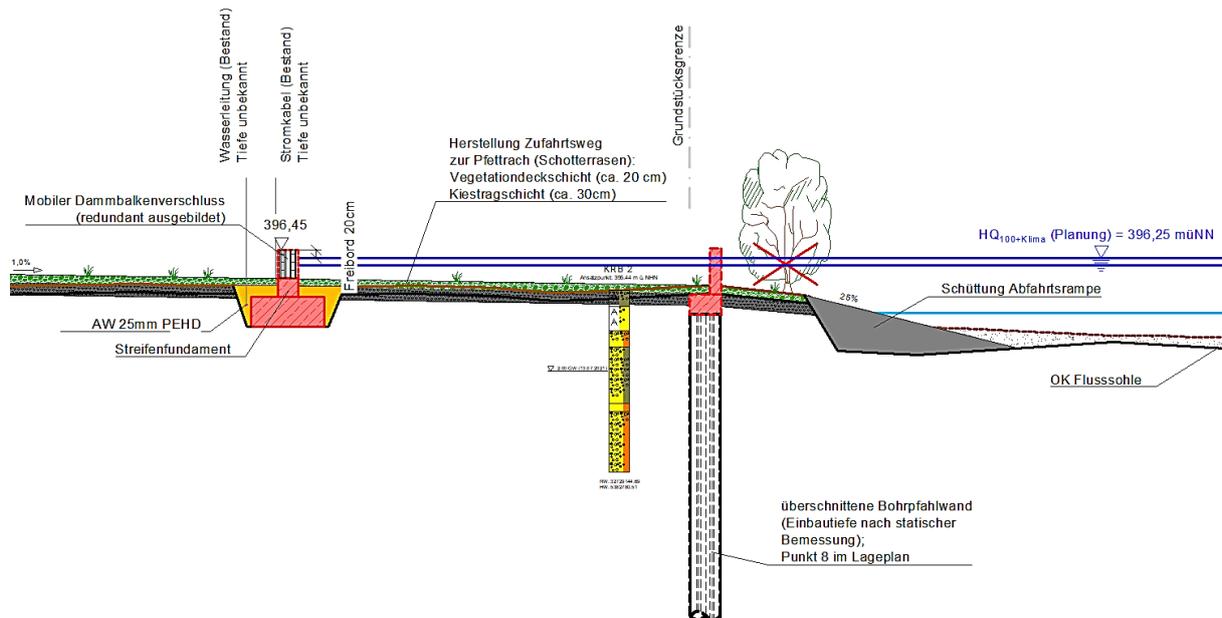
Schotterrasenweg mit Rampe in die Pftetrach (Ausschnitt aus Plan E33)
